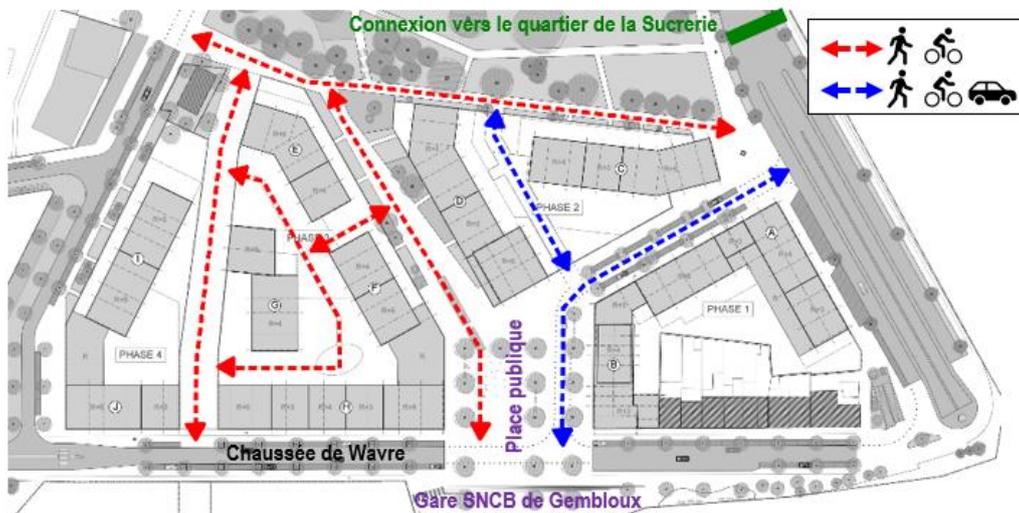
Accessibilité du projet d'ensemble (ARIES sur fond de plan Julien Barrere Architectes, 2018)
